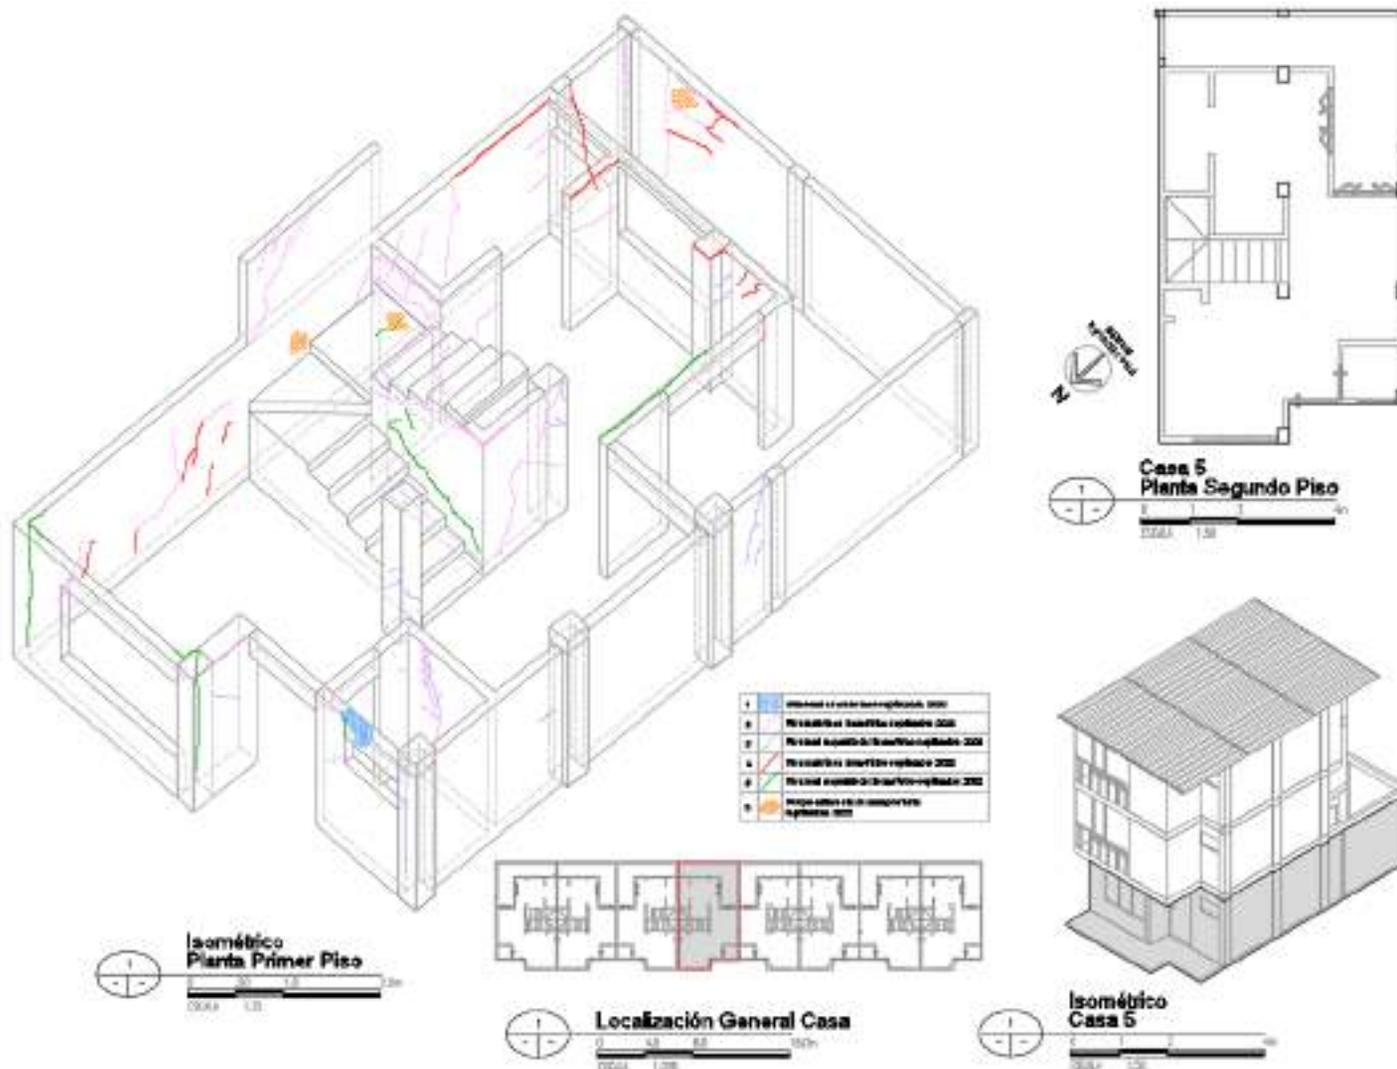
Levantamiento de daños primer piso Casa No. 5.
